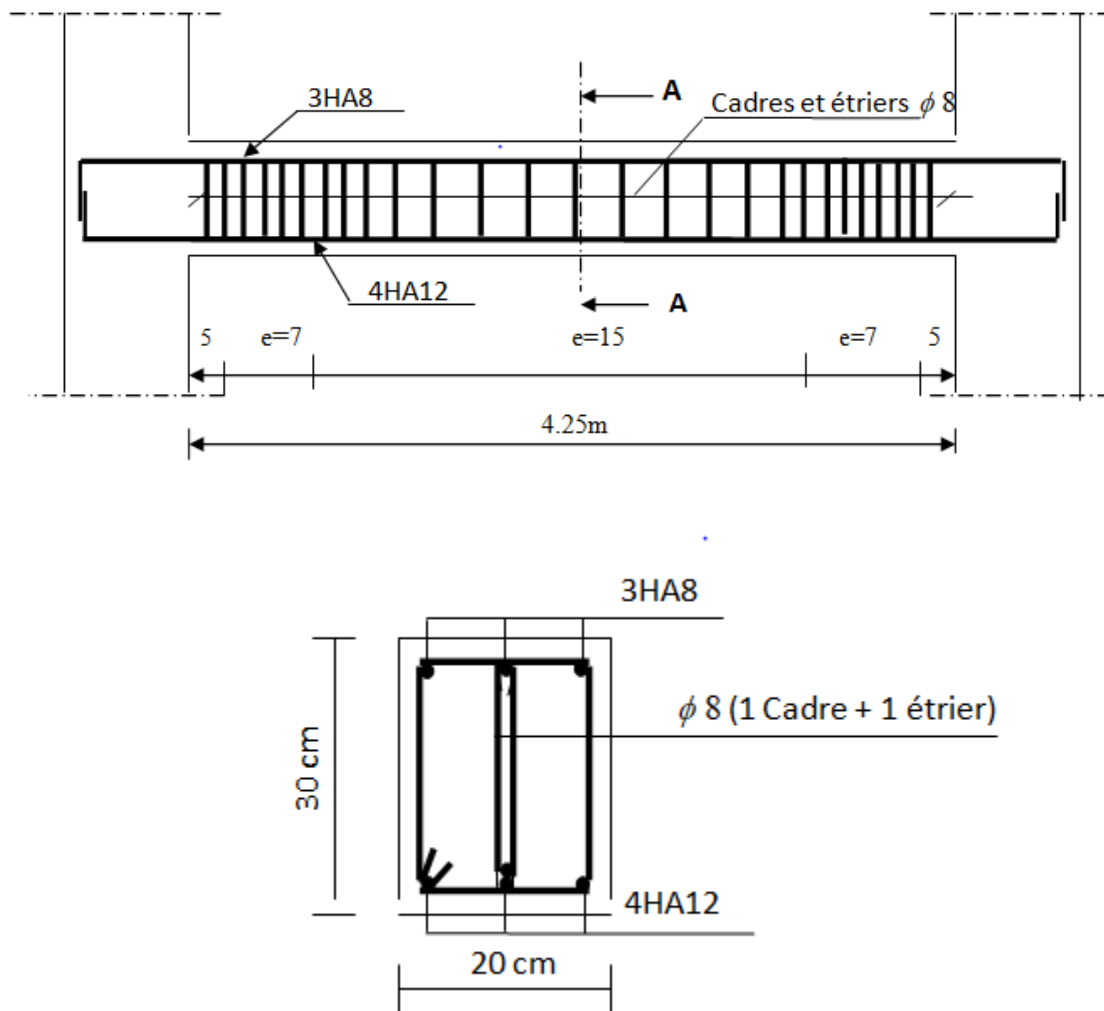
Ferrailage de la poutre de chaînage I.
